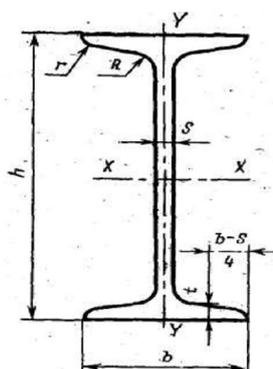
Металлическая двутавровая балка: высота двутавра; b – ширина полки; s – толщина стенки; t – толщина полки; R – радиус внутреннего закругления; r – радиус закругления
